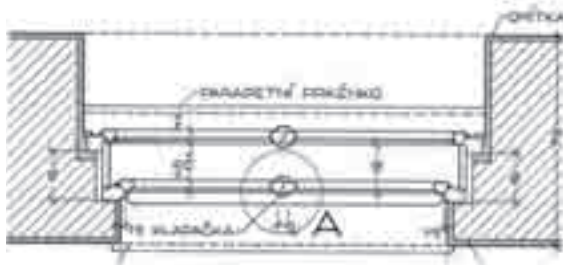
Detail uzavíracího kování zvaného españoleta. Svislá otočná tyčka je ovládána klíčkou.
